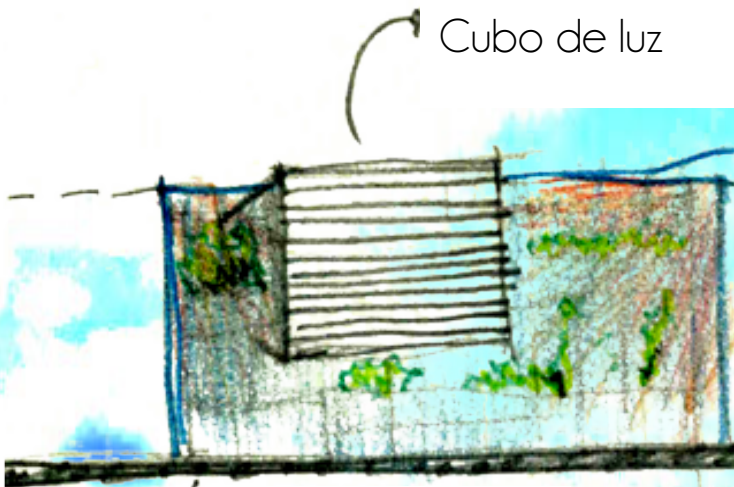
"bocetos a mano alzada, Elaboración propia 2010
